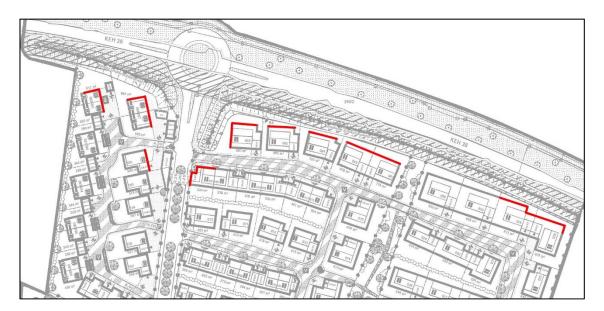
Lageplan mit Kennzeichnung der Fassaden, an denen Schallschutzmaßnahmen zum Schutz von Schlafräumen erforderlich sind (nördlicher Bereich)
